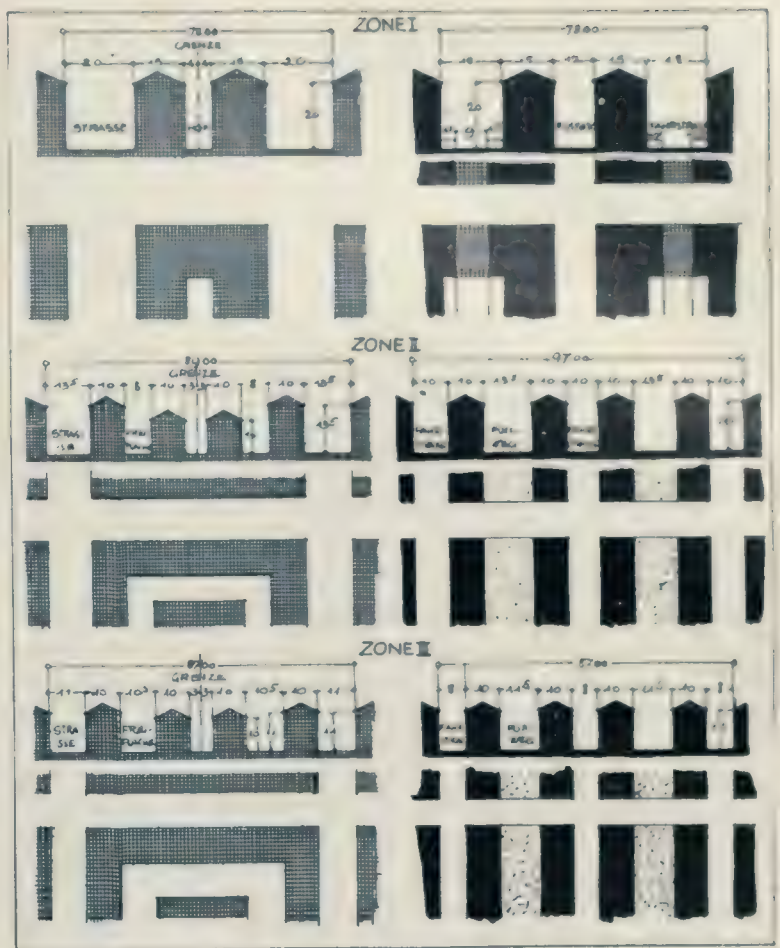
Alte und neue Bauweise nach den Stuttgarter Bauregeln.
